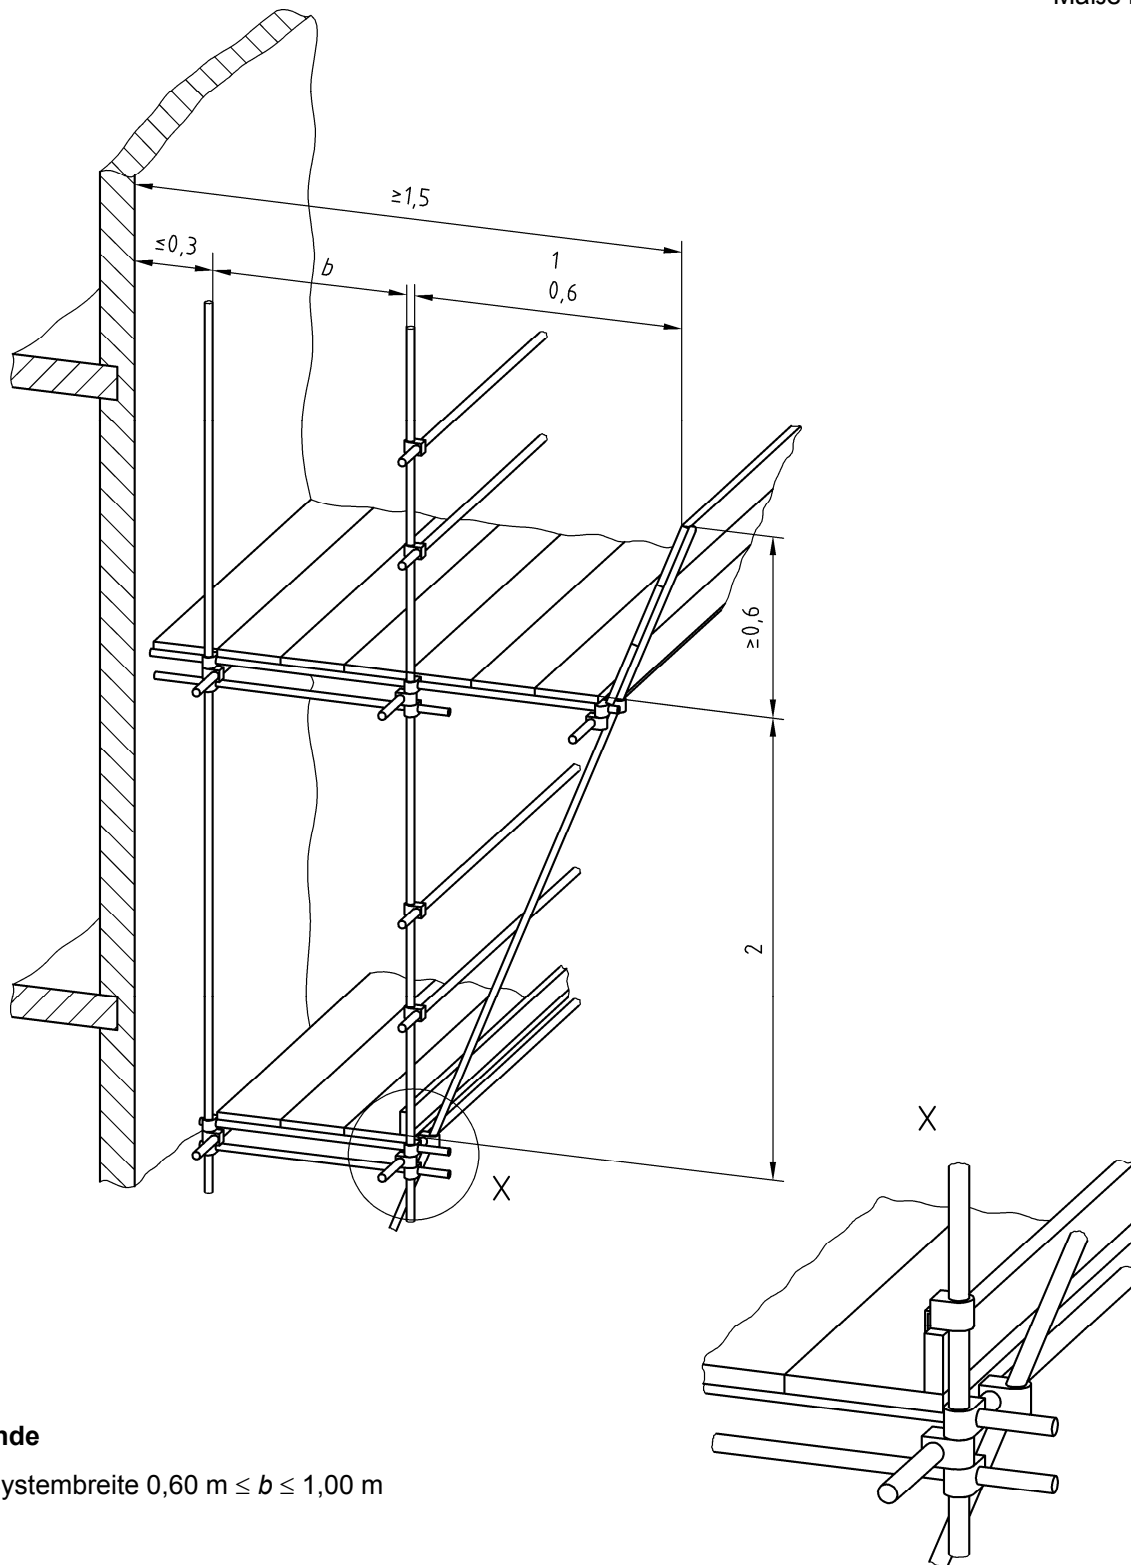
Verbreiterung für die Regelausführung der Stahlrohr-Kupplungsgerüste als Standgerüste mit längenorientierten Gerüstlagen
